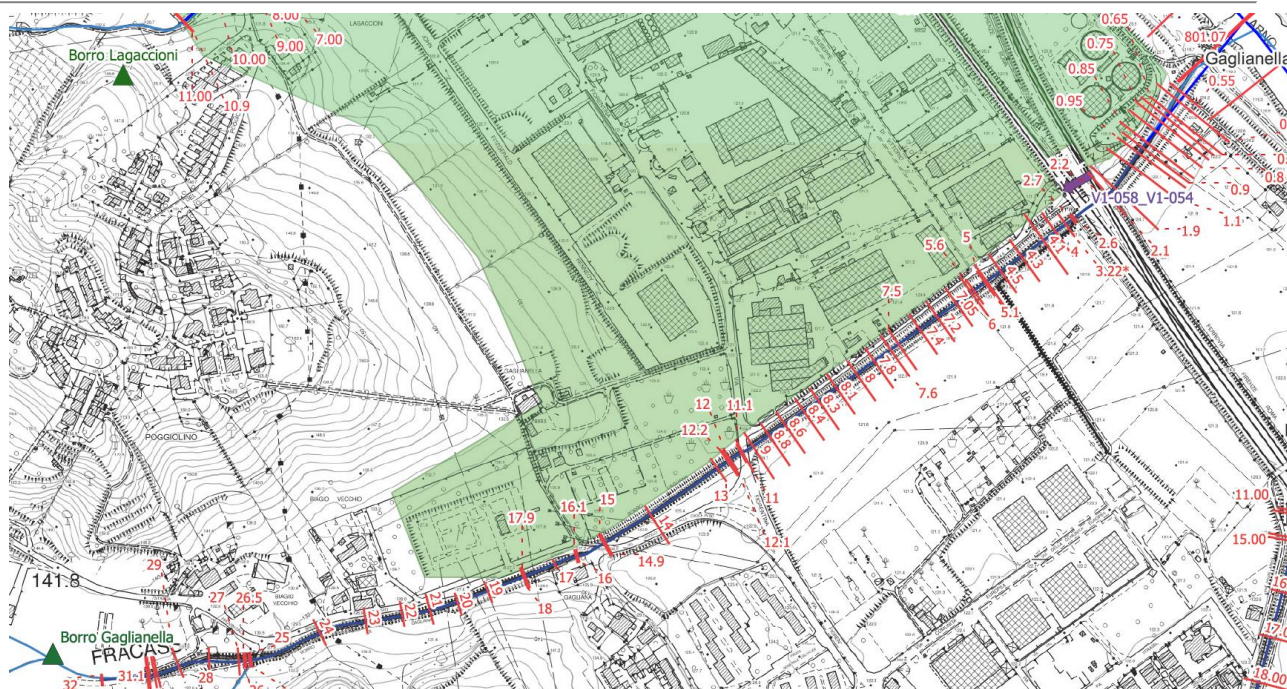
estratto tavola D0.11 Progetto esecutivo Cassa di Espansione di Prulli - Planimetri modello idraulico
